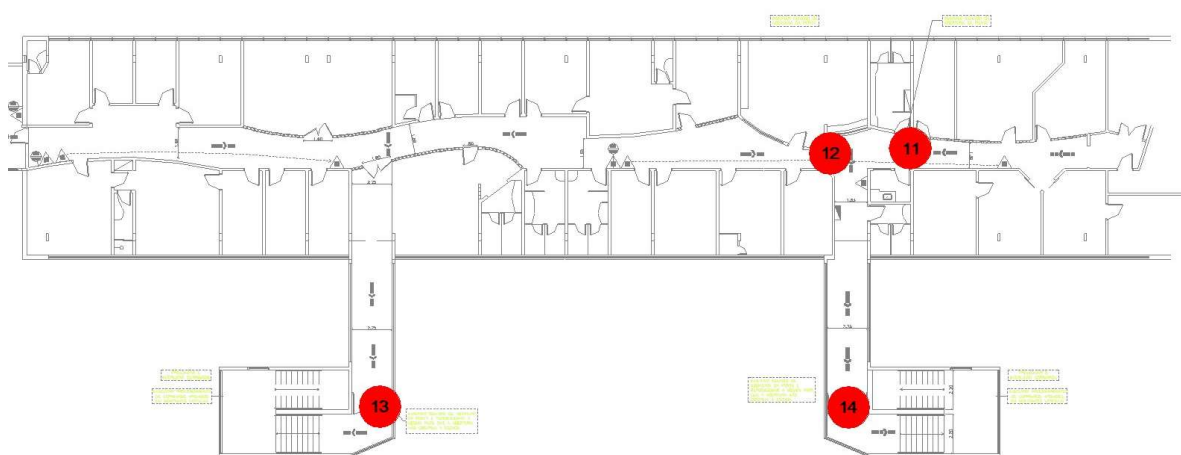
Planta 1º pavimento Prédio da Reitoria
